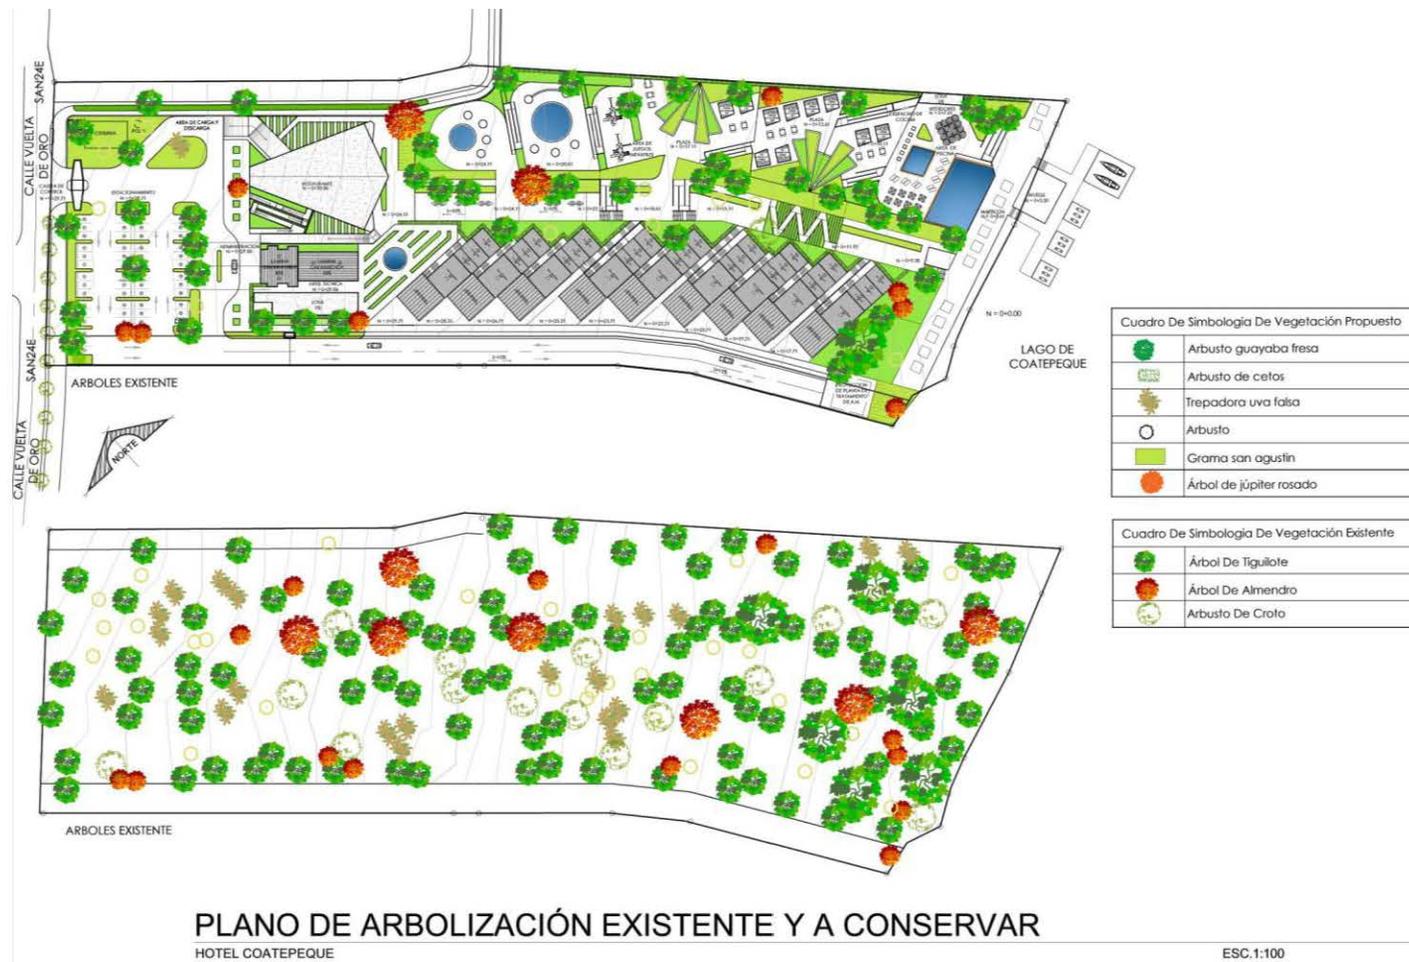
Planta de arborización existente. Fuente: elaboración propia.
